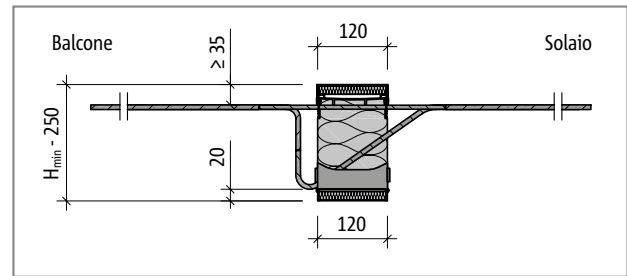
Schöck Isokorb® tipo KXT45, KXT50, REI120: sezione dell'elemento
